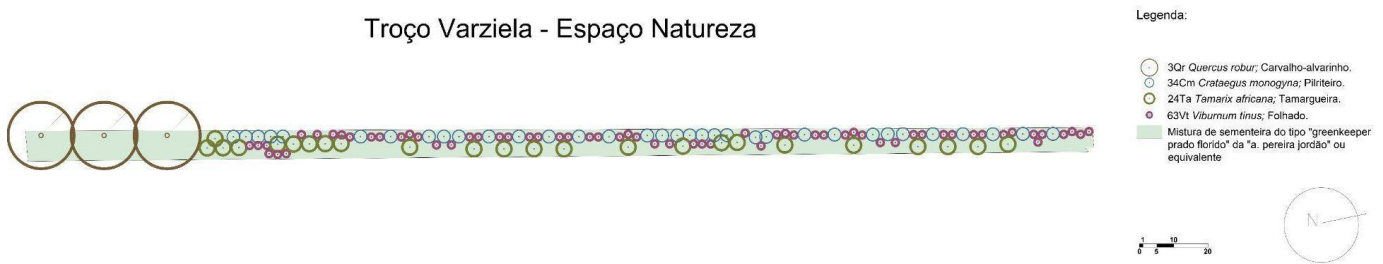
Plano de Plantação troço entre a estação Varziela e Espaço Natureza (Fonte: Autor)
